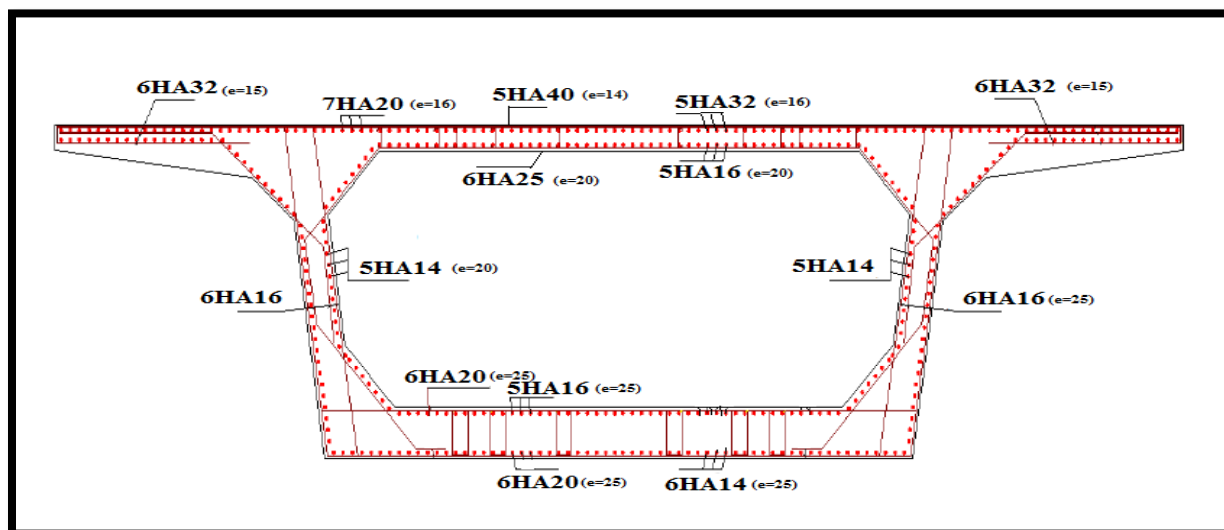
Schéma de Ferrailage du voussoir sur pile
